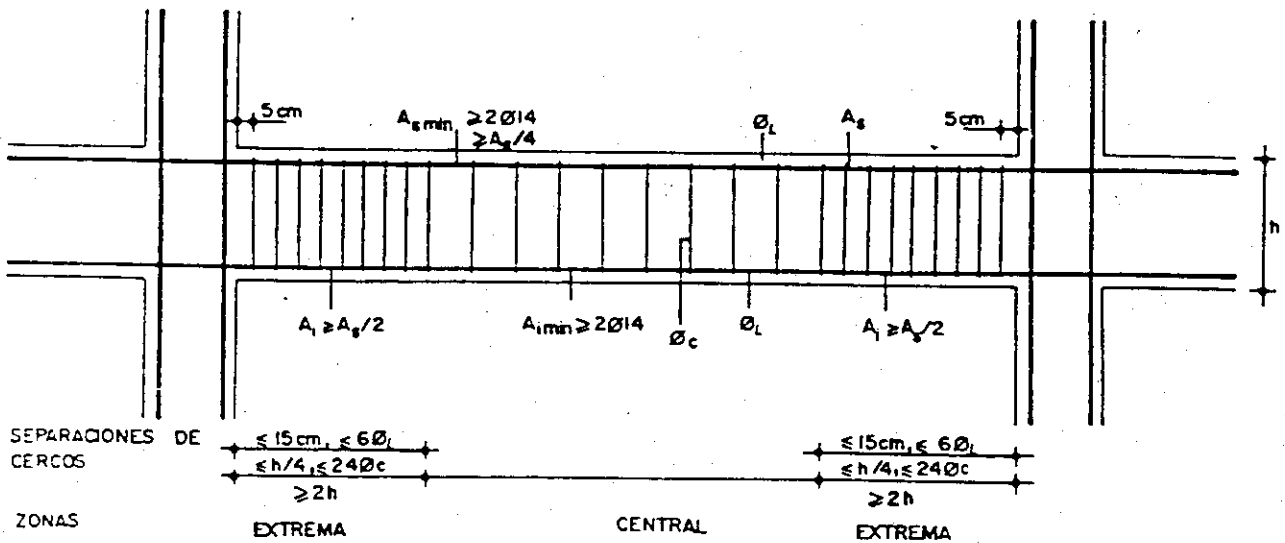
Viga de hormigón armado ductilidad muy alta. Armaduras mínimas.
